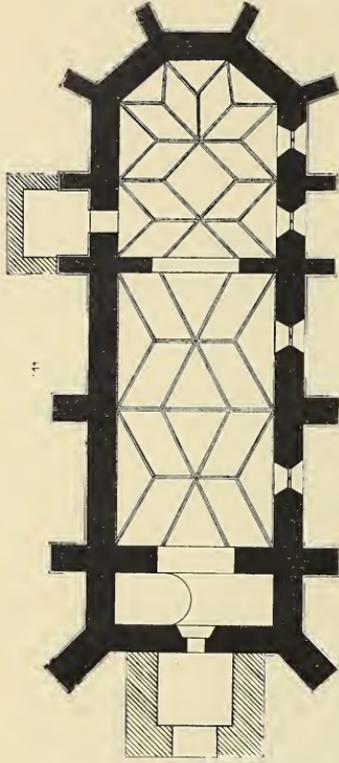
Grundplan der Pfarrkirche zu Nagyvázasony.
